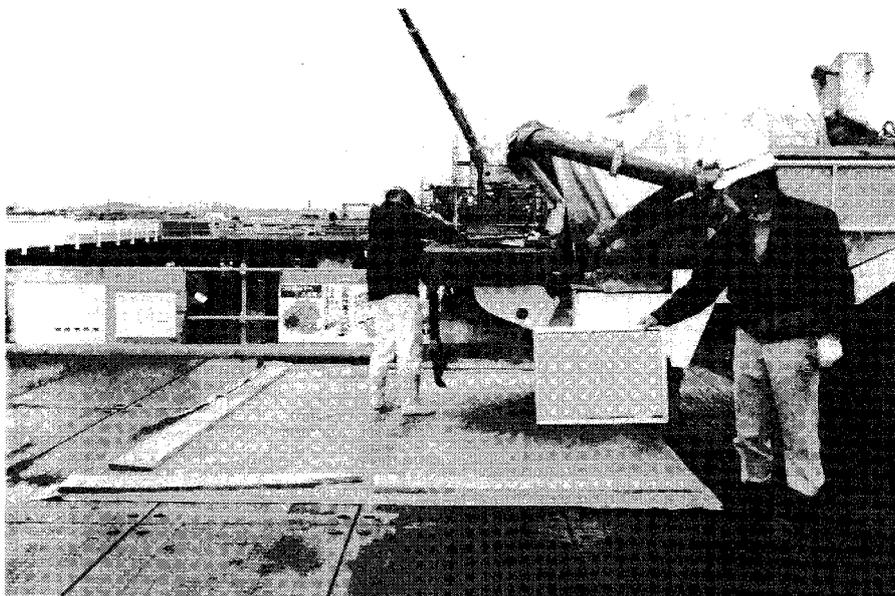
コンクリートポンプ車後方のシート敷設状況
